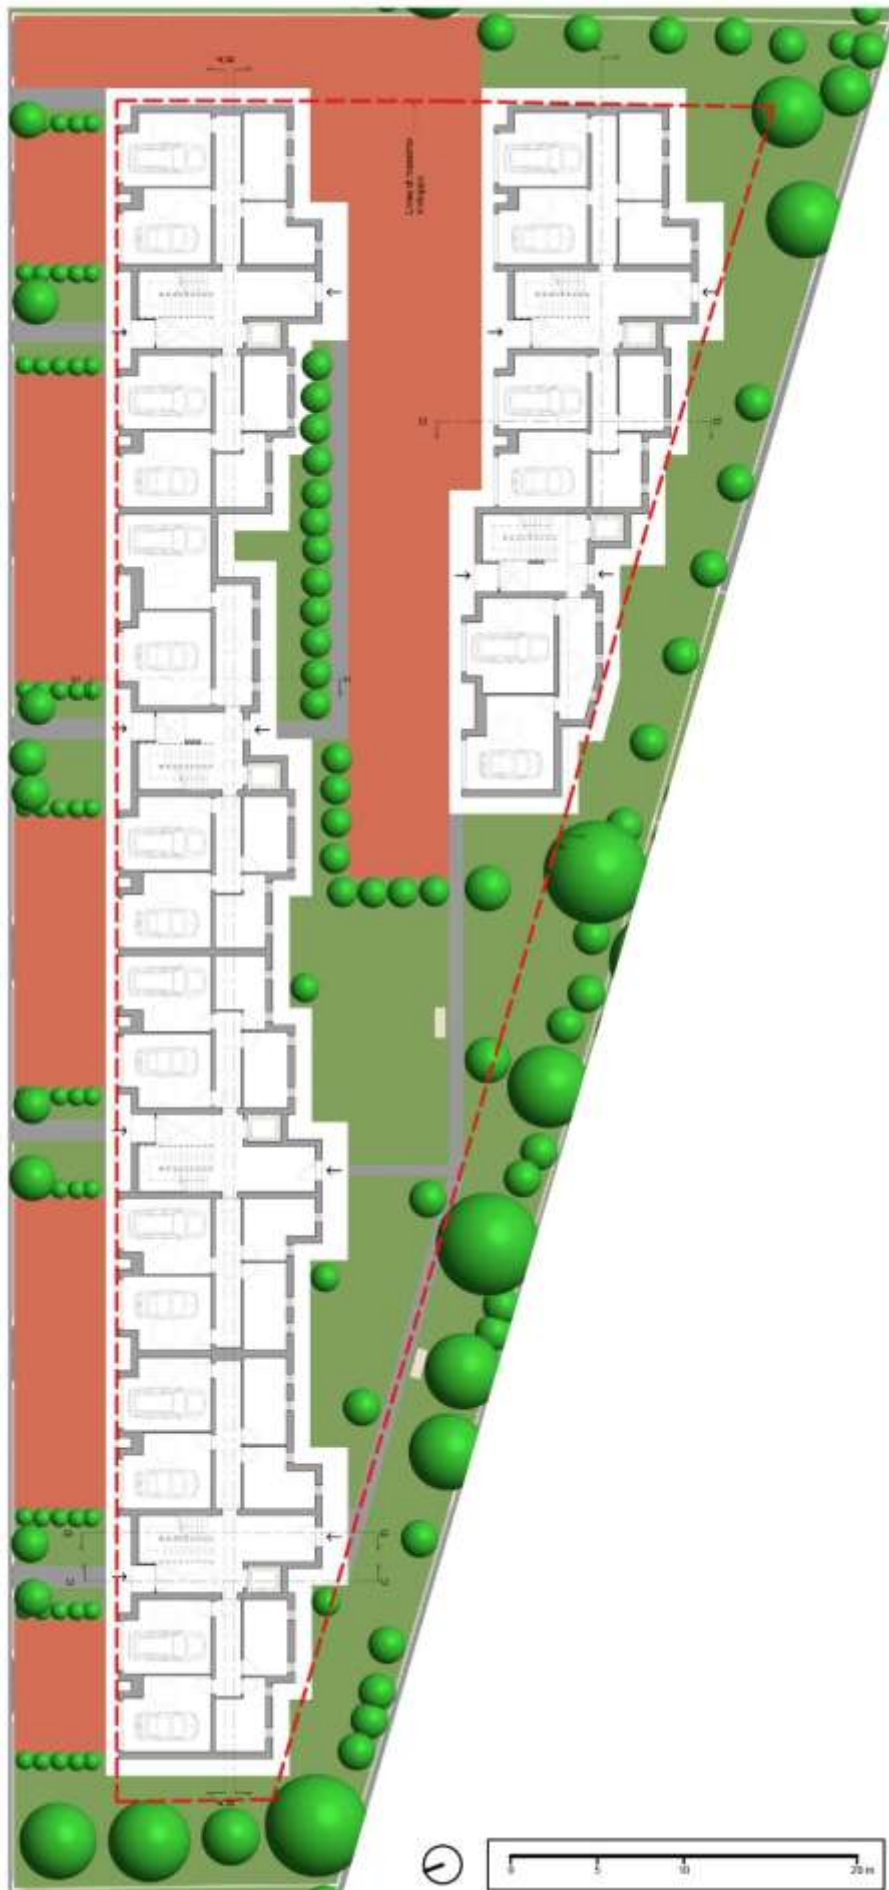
Masterplan P00. [Fonte: elaborazione dell'autore]
